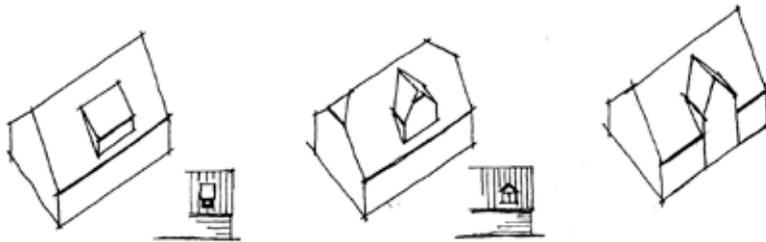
ortsbildtypische Dachformen und Dachgauben
